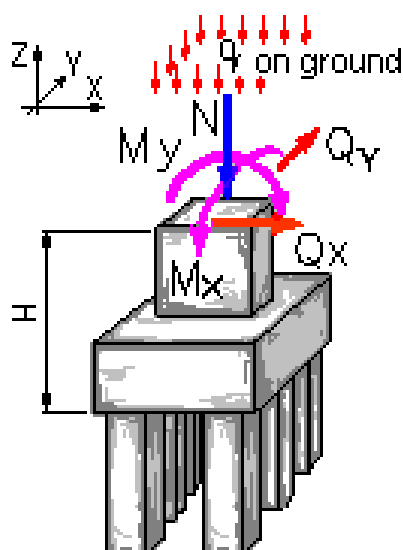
Схема дії навантажень на палевий фундамент
